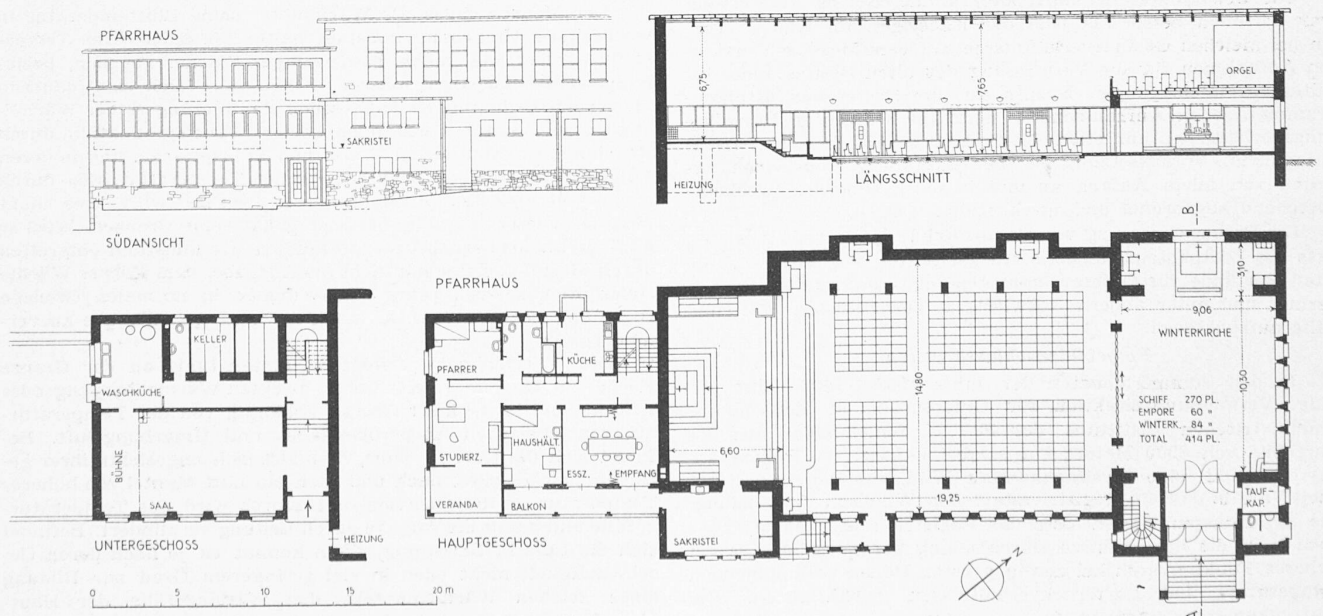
Grundrisse und Ansicht der Baugruppe, sowie Längsschnitt der Hauptkirche. — Masstab 1:400. — Arch. W. SULSER, Chur
